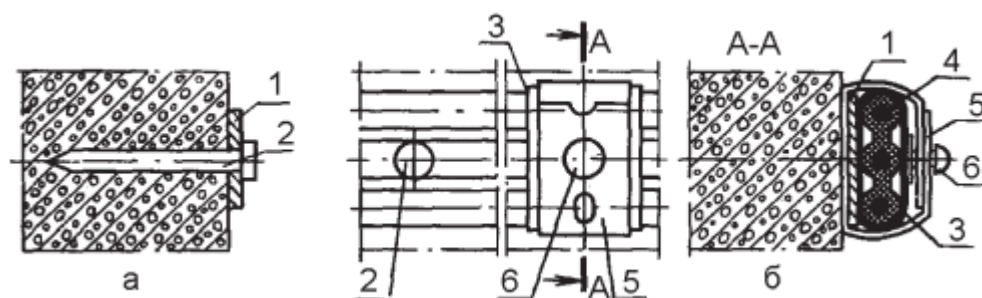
Крепление проводов марок АПВ, АППВ, АПН, АПРВ к бетонным основаниям по пристреливаемой стальной полосе: а – крепление полосы дюбель-гвоздем; б – крепление провода: 1 – полоса; 2 – дюбель-гвоздь; 3 – прокладка из электрокартона; 4 – провод АПН 3×4; 5 – лента монтажная; 6 – монтажная кнопка
